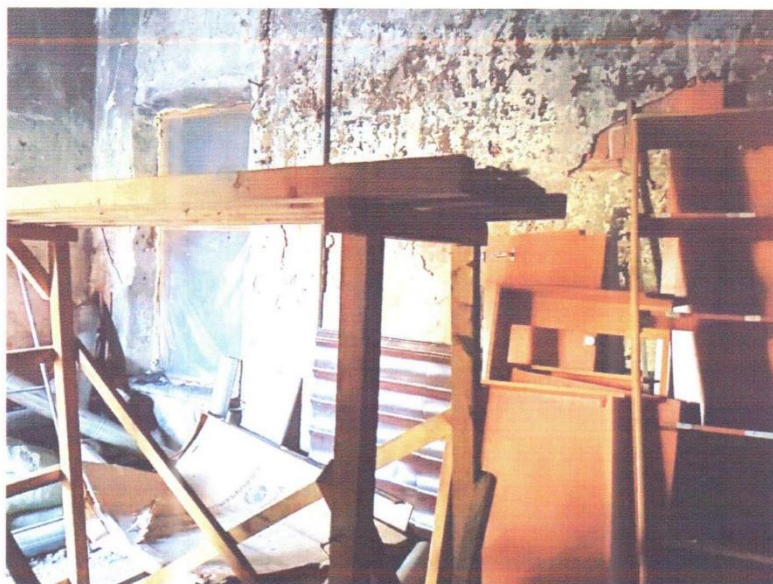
Помещение загромождено строительным мусором и разобранной мебелью. Вход в соседнее помещение загерметизирован.
